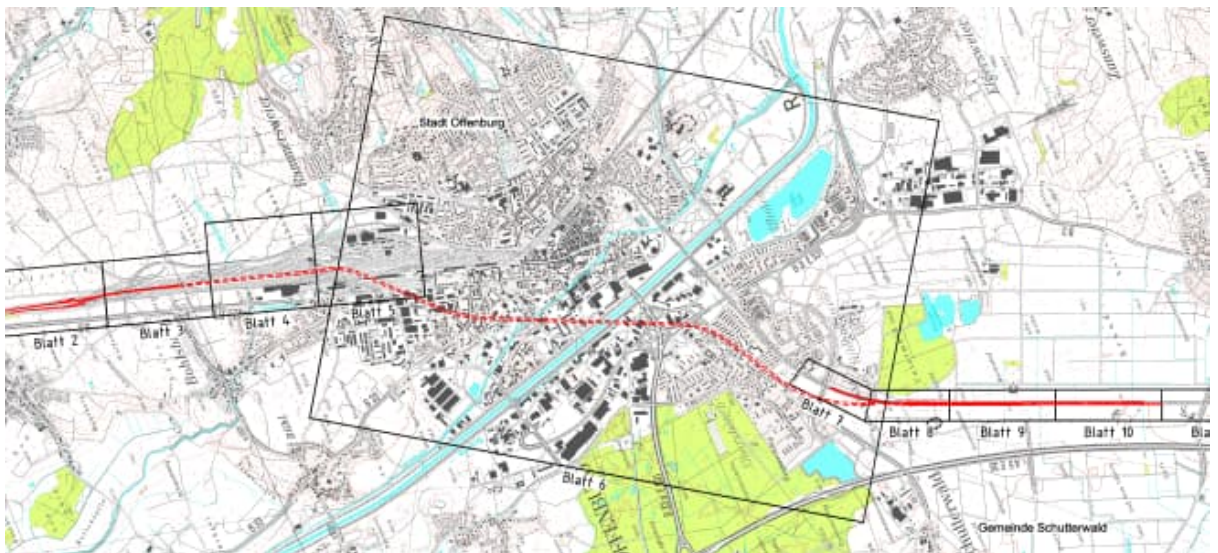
Übersichtslageplan Variante Güterzugtunnel
